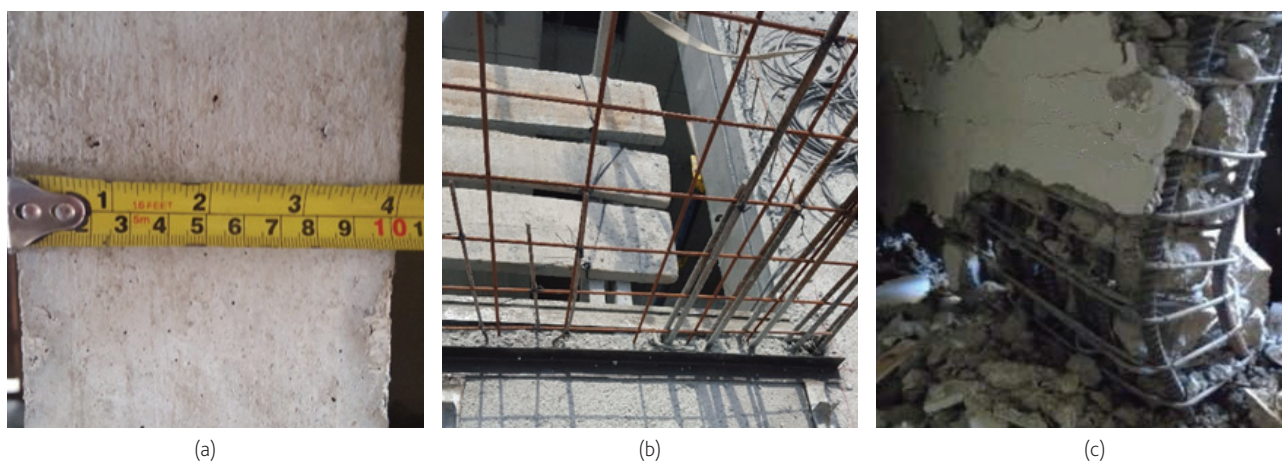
Paredes típicas da construção Colombiana, com apenas uma camada de armaduras: (a) Espessura da parede; (b) Detalhe das armaduras (fotografias gentilmente cedidas por Lisandro Jimenez); (c) Exemplo de danos envolvendo o colapso para fora do plano numa parede de betão armado, durante o sismo de 2011 na Nova Zelândia [2]
